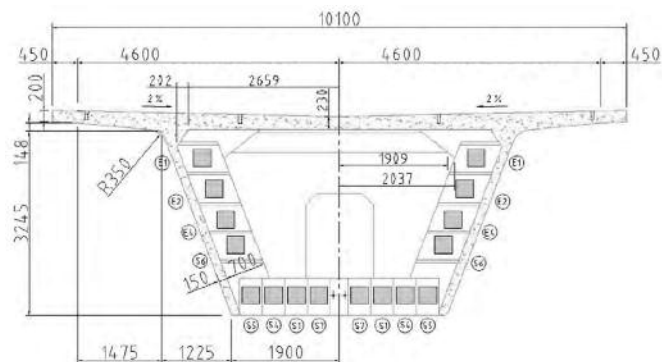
Coupe du voussoir sur pile au niveau des ancrages des câbles de précontrainte / Segment on pier cross section with prestressing anchorages.
